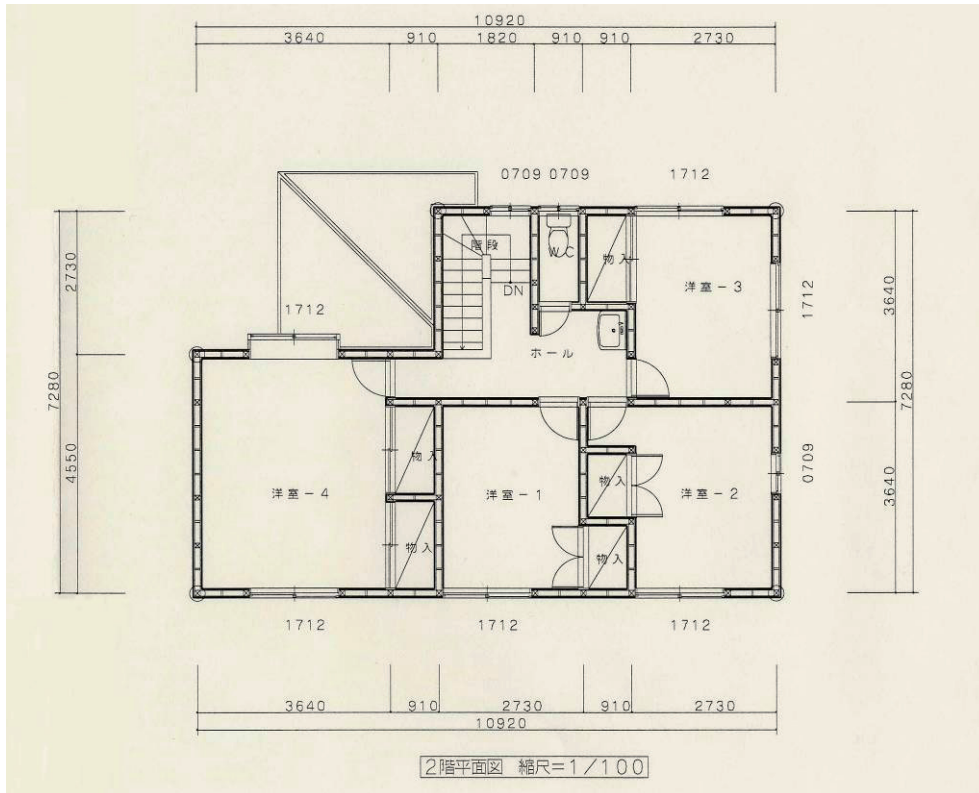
公庫標準仕様モデル図面 2階平面図
